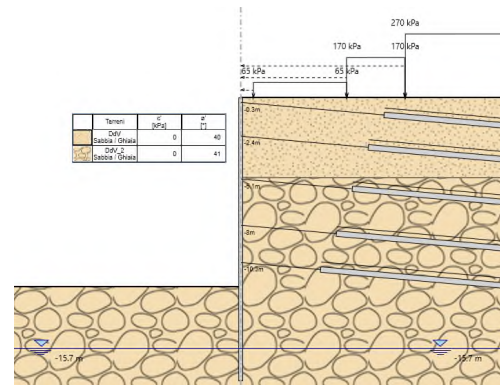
Raggiungimento fondo scavo (Stage 14)
